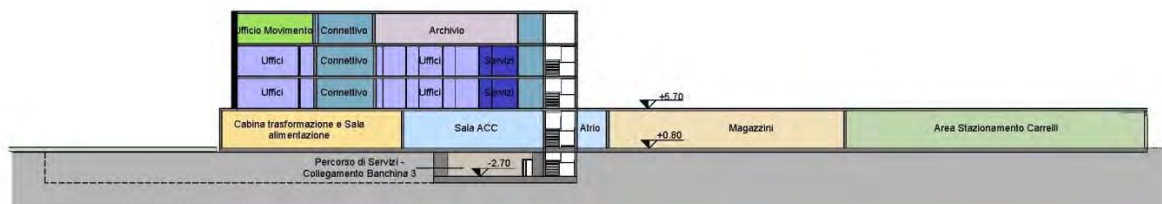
Estratto Tav 2.1.4.2 - Sezione CD RFI
